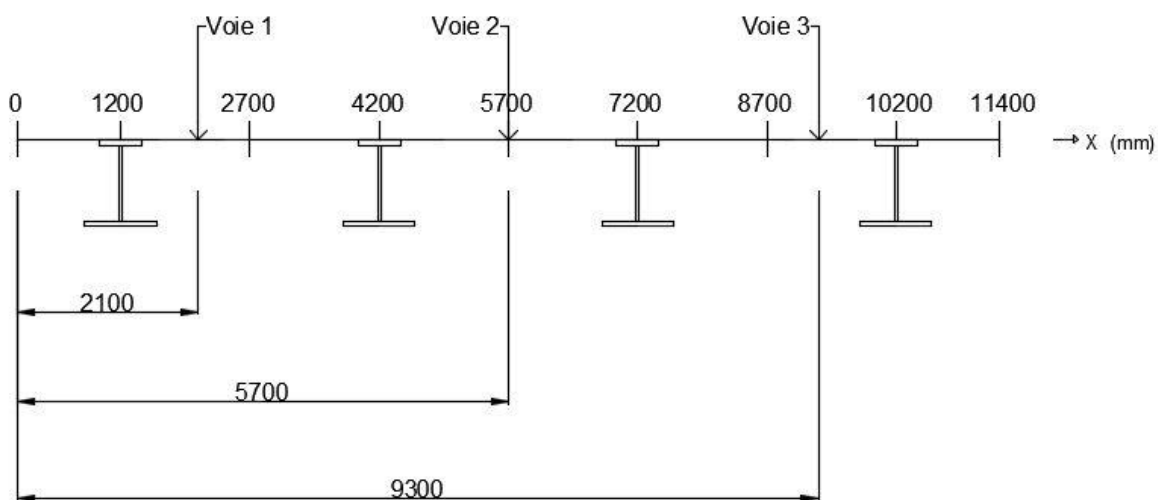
Coupe transversale du pont modélisé sur CSI Bridge
